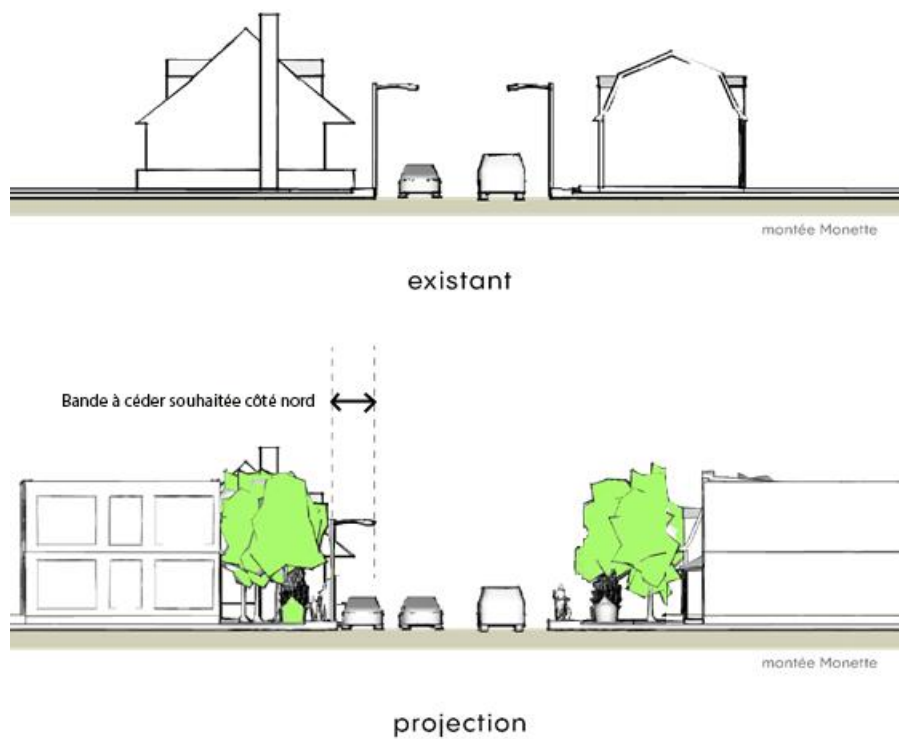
Montée Monette : coupes de rue (conditions existantes en haut et projetées en bas) illustrant la largeur supplémentaire de la chaussée, la largeur de terrain à céder et le stationnement sur rue
